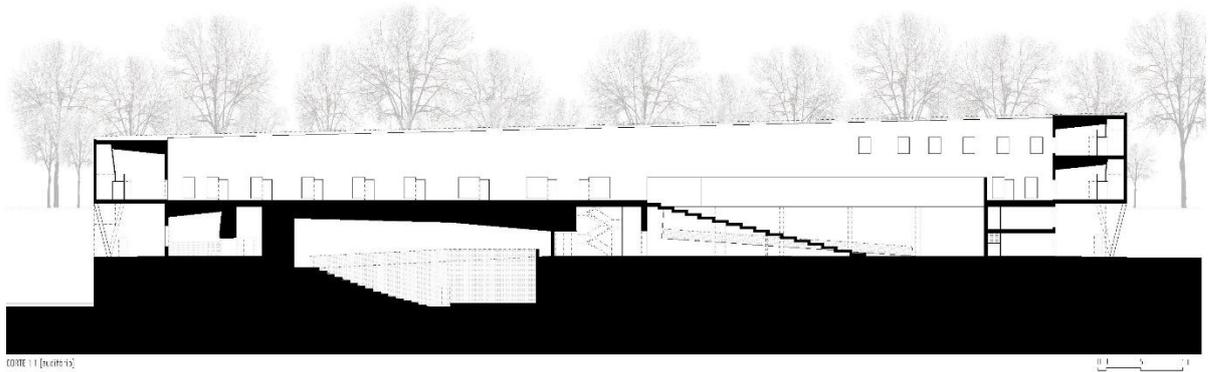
Corte Longitudinal (FONTE: Open Buildings, 2013).
